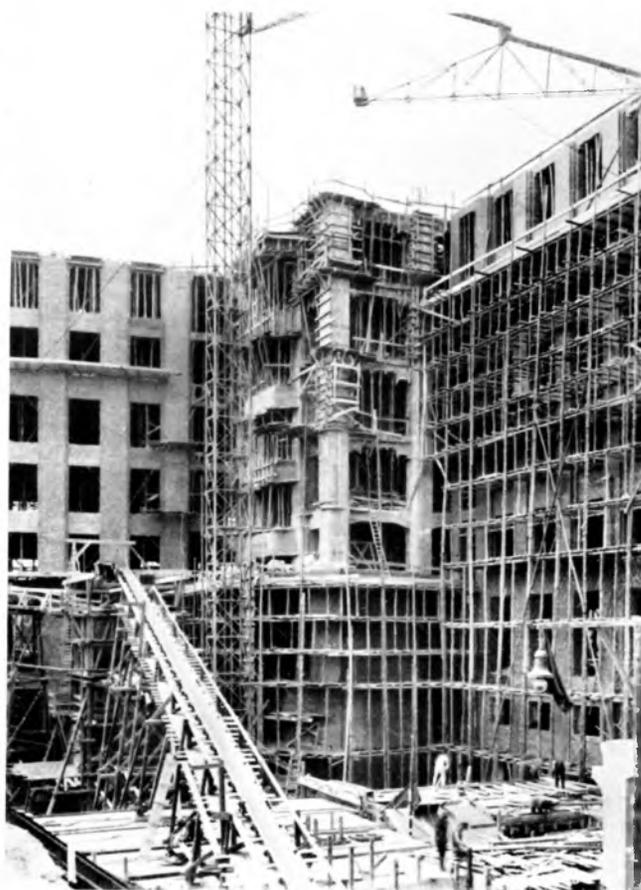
Ausgeschaltete Eisenbetonkonstruktion der unteren Turmgewölbe
